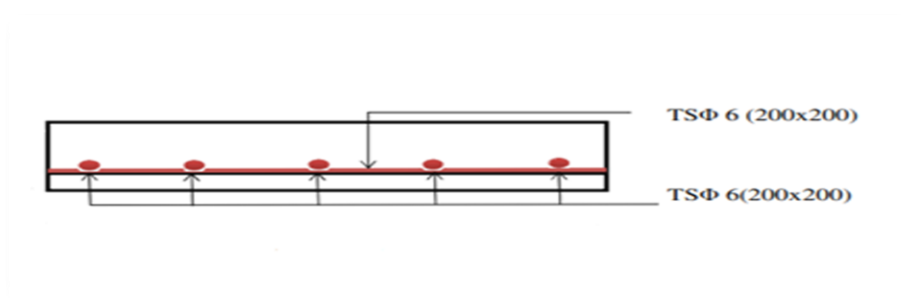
FERRAILAGE DE LA POUTRELLE
